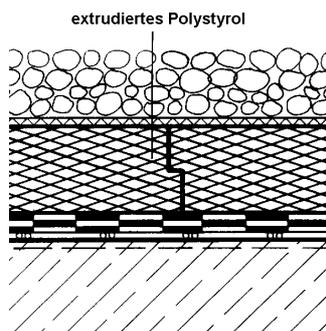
UK-Dach mit unterläufiger Abdichtung im Schadensfall
